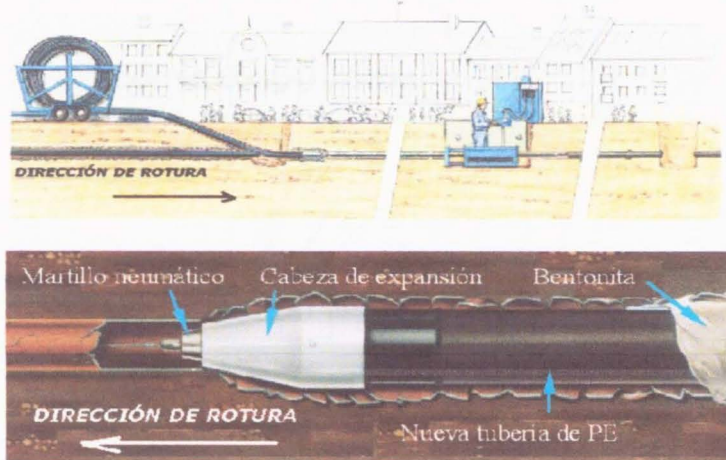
TÉCNICA DE ROTURA DE TUBERÍA (ARRIBA). DETALLE DE LA FRACTURA DE TUBERÍA (abajo)⁴
